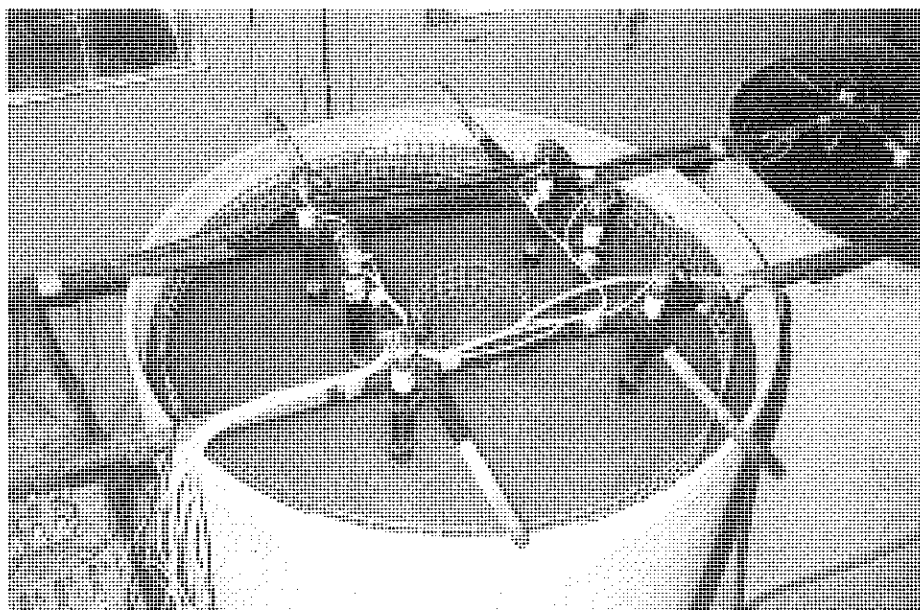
Fotografía del montaje para provocar la corrosión acelerada de las armaduras
